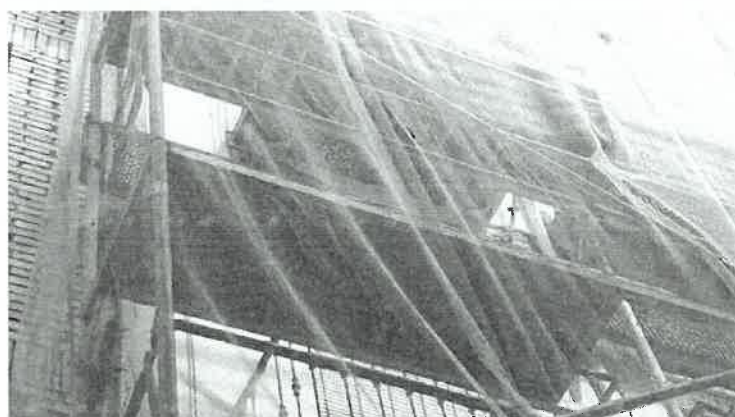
Detalle ornamentación de fachada. Febrero 2019
